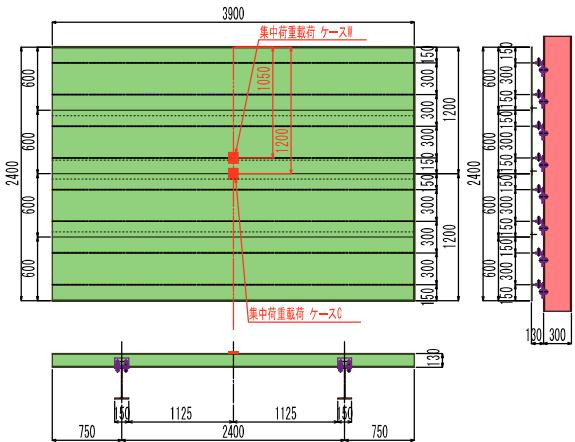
鉛直力載荷試験（集中荷重）の供試体概要図
